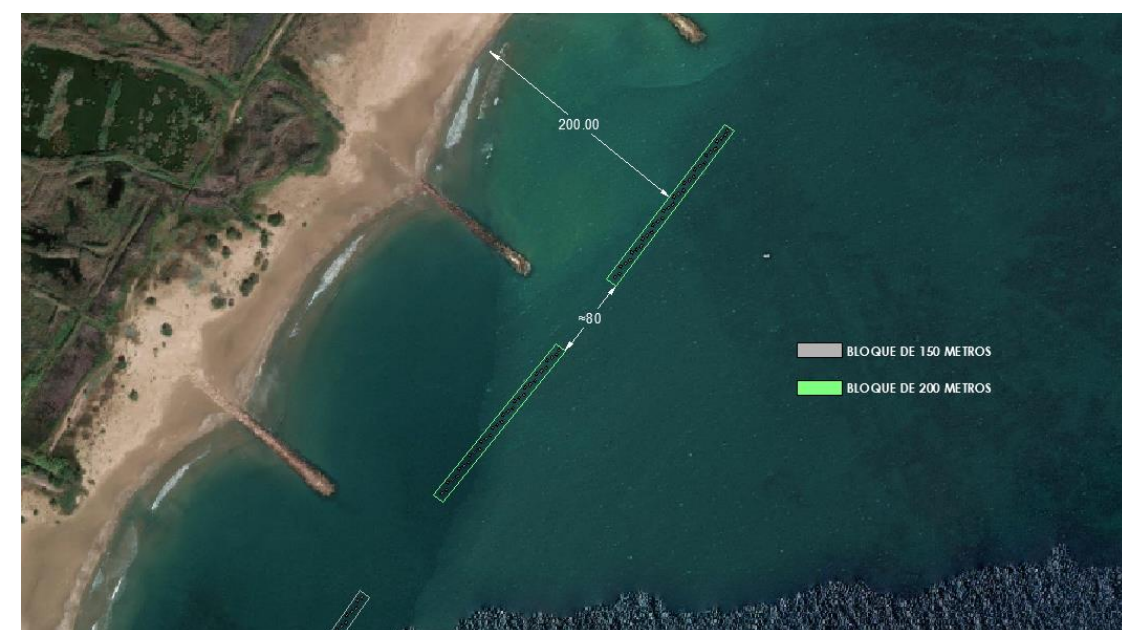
Distribución de los bloques. (Fuente: plano 7.8, 2023)
